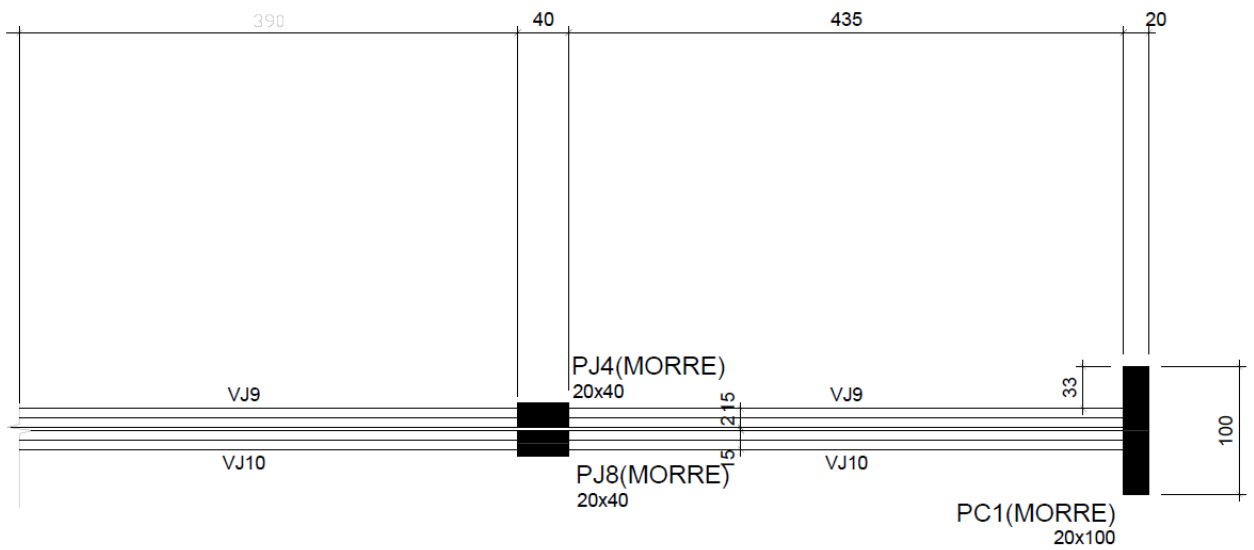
Vigas à serem reforçadas na junta da garagem (Seção B)
